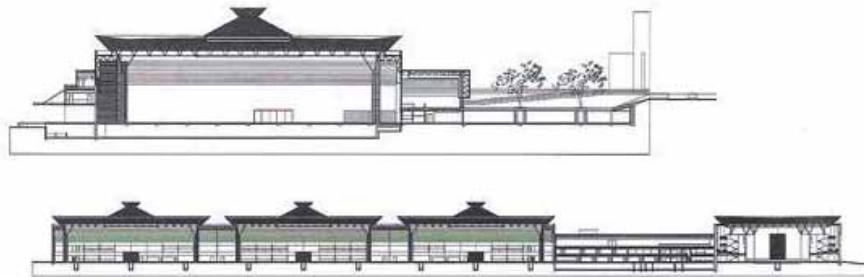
EXPO MINAS-Corte e Elevação. Fonte: Revista FINESTRA47 - pag70.
